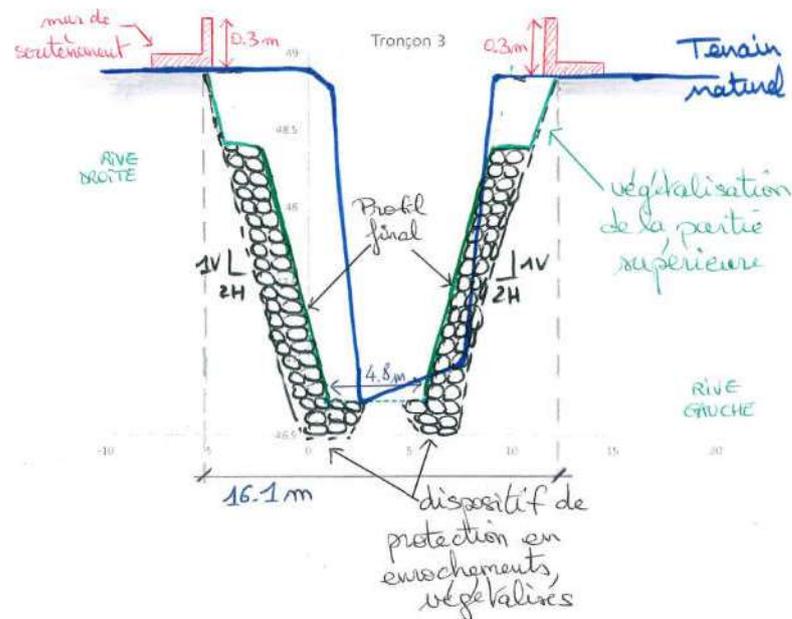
Coupe type des travaux projetés– secteur Galamina (Source : setec hydratec)
